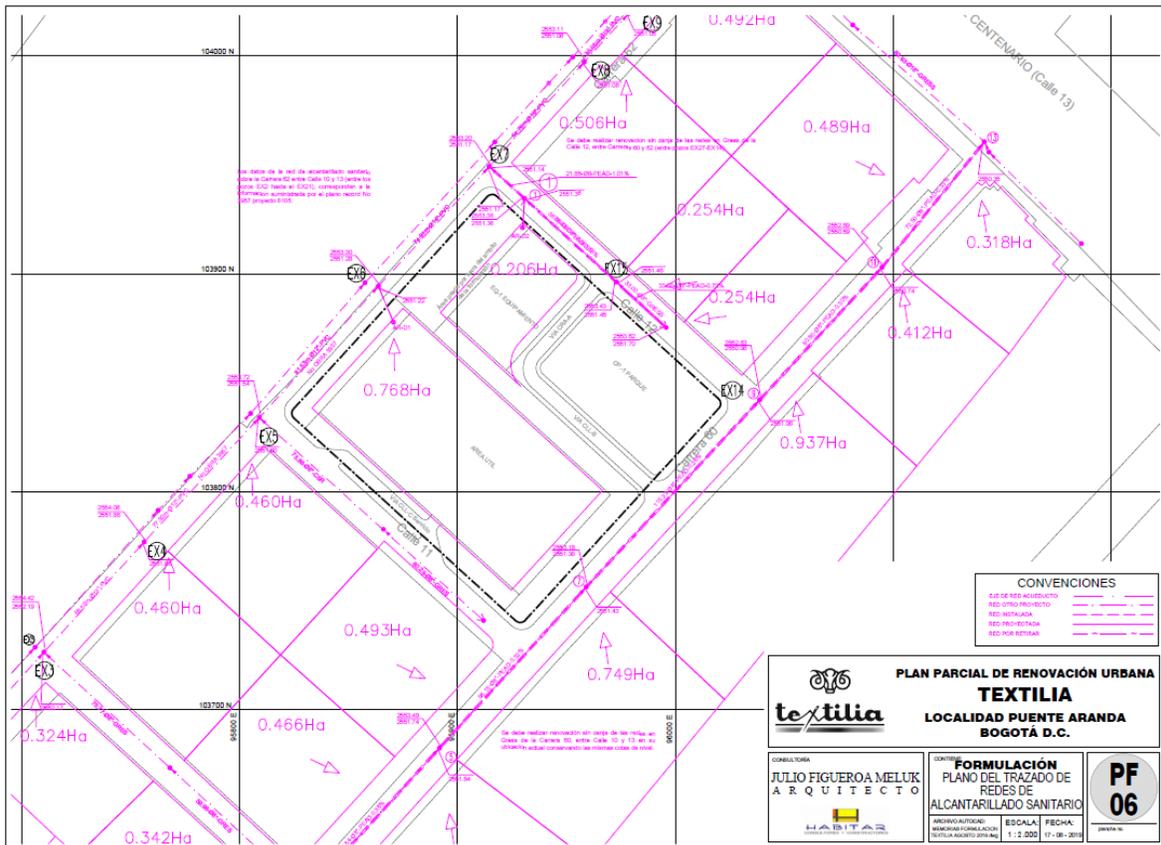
Plano PF-06 Trazado de Redes de Alcantarillado Sanitario
